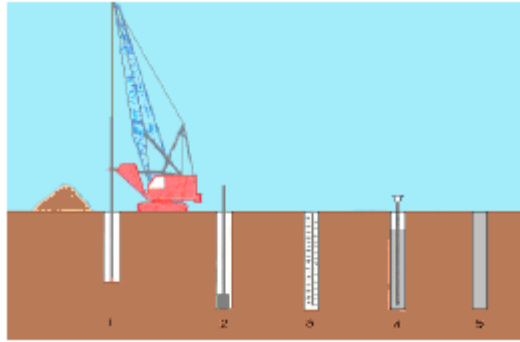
Proceso constructivo de pilotes colocado in situ.
